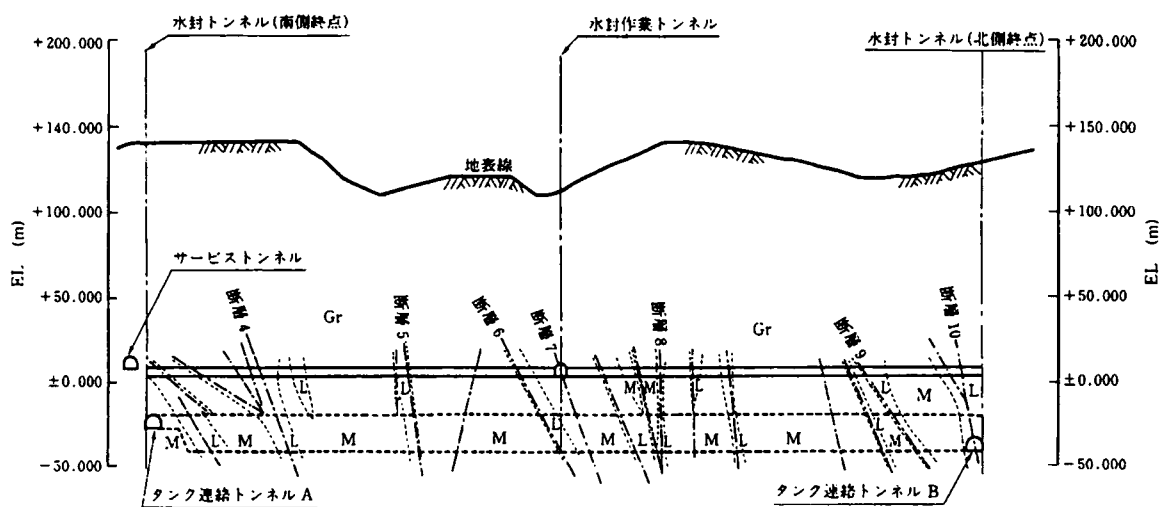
13. 1 地質断面図 (水封トンネル No.1 断面, No.2 断面)
